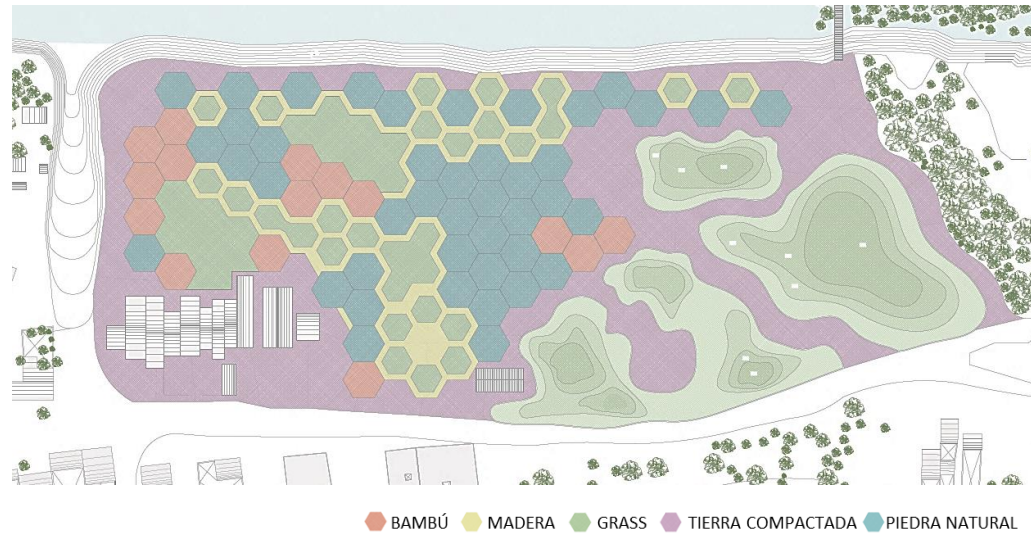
Tipos de pavimentos del Centro Ecológico. Fuente: Elaboración propia.
